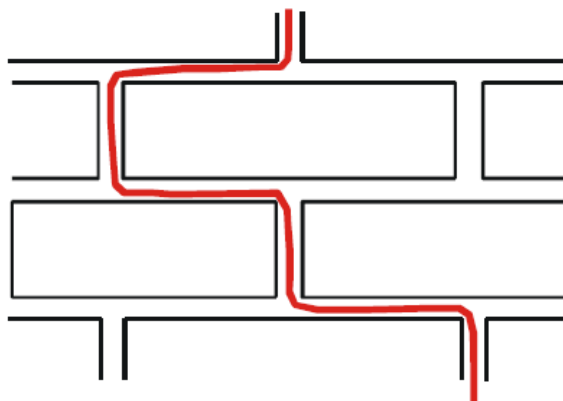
Fissura típica em parede de alvenaria homogênea.
